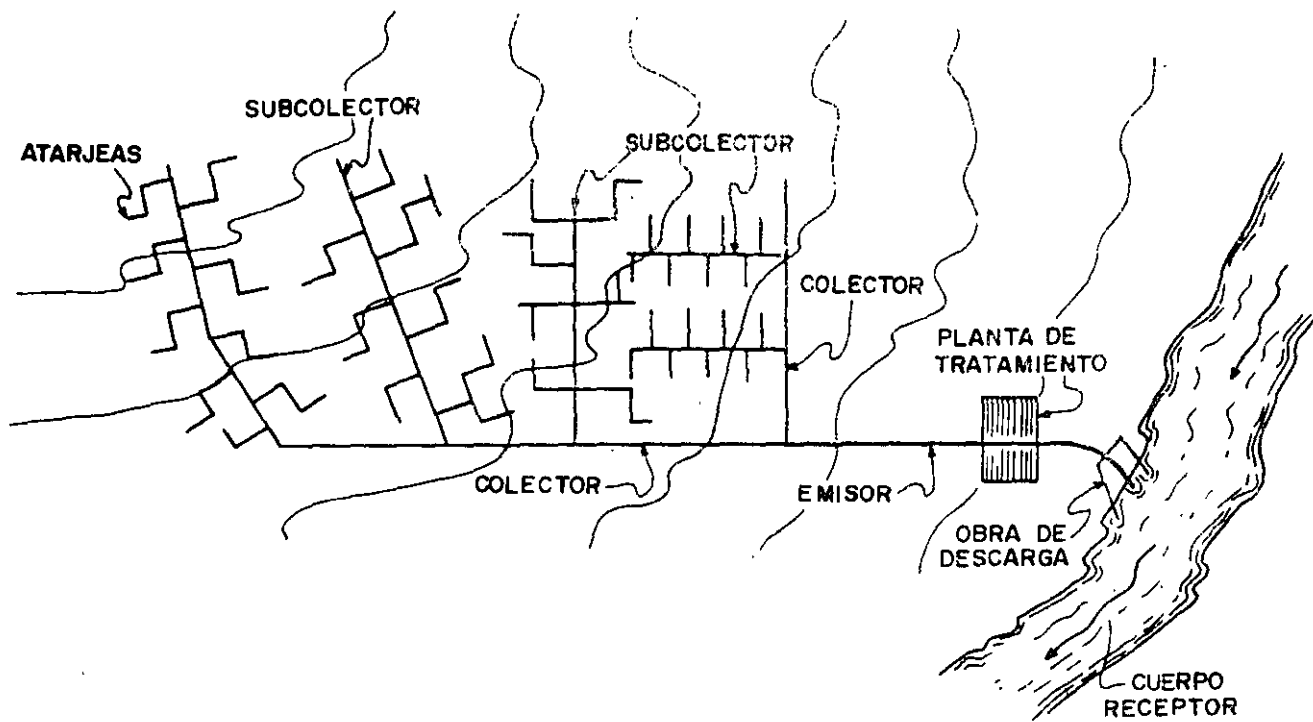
Conductos que forman la red de un sistema de alcantarillado.
